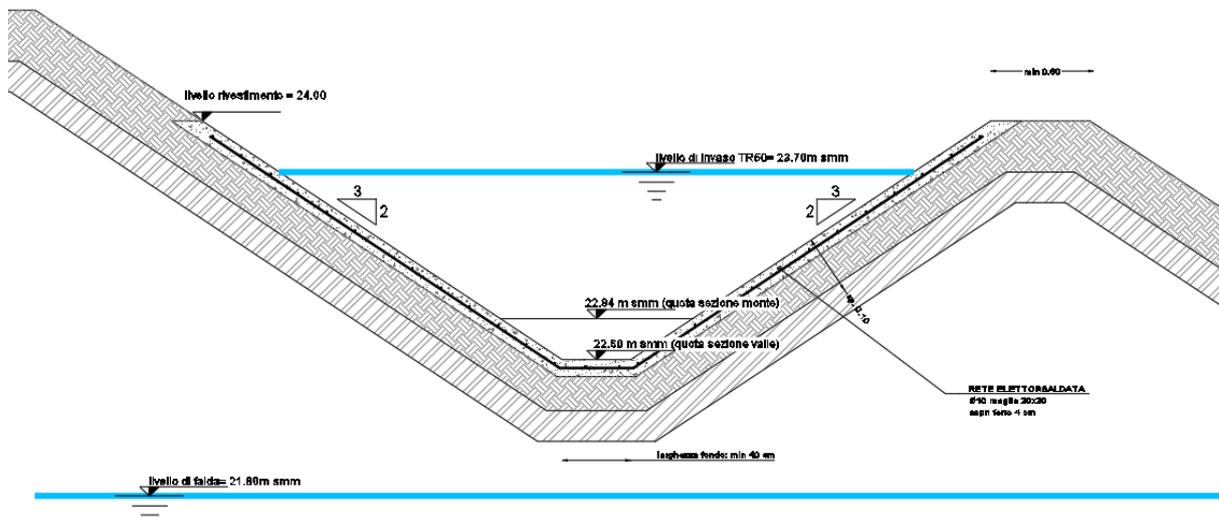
sezione tipo canale di invaso e laminazione rivestito.
